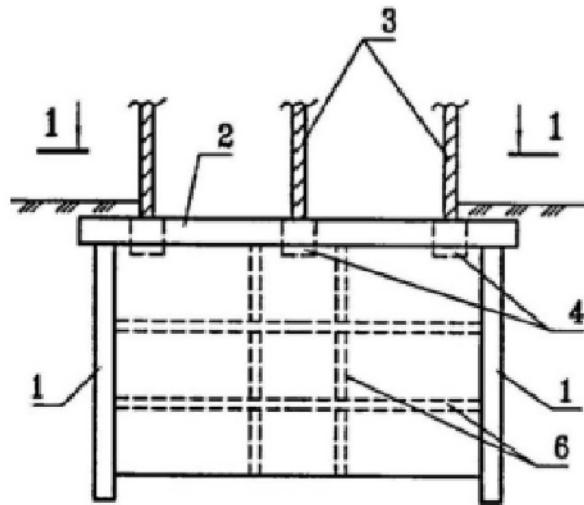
Схема влаштування підземного поверху: 1 - стіни підземної споруди; 2 - залізобетонна несуча плита; 3 - несучі стіни будівлі; 4 - фундаменти; 6 - конструкції підземних поверхів
